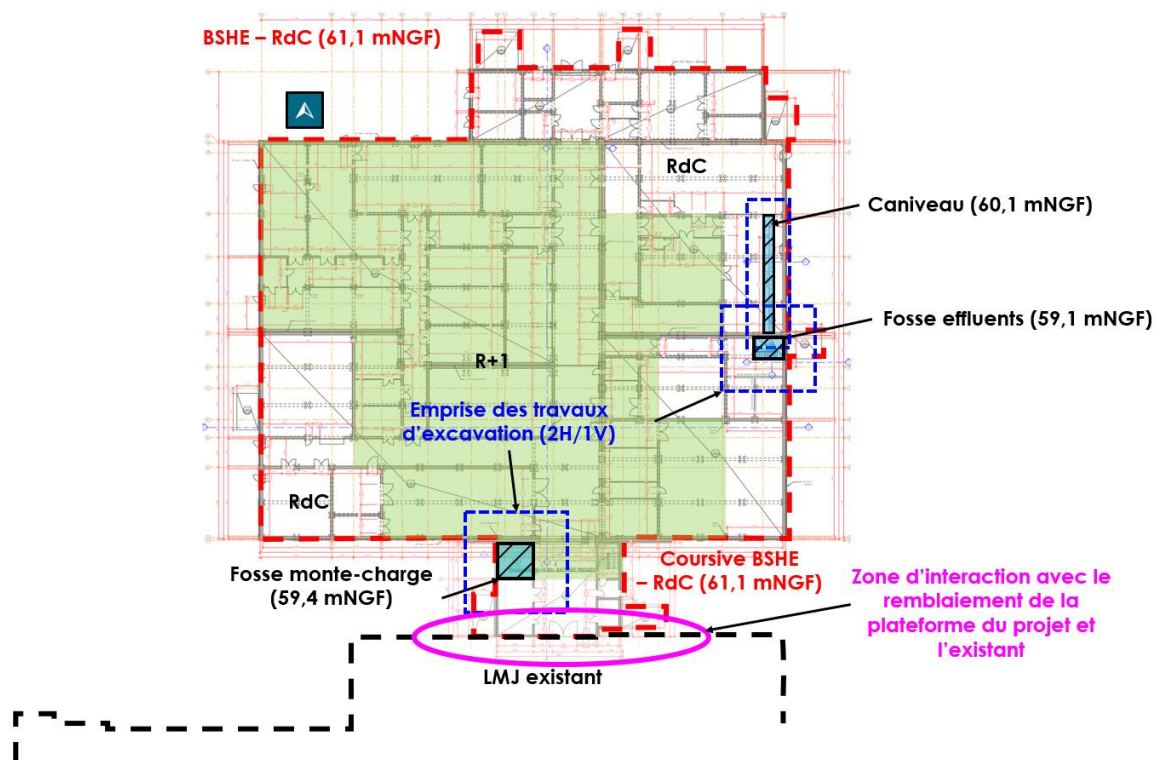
Zone d'emprise des travaux d'excavation – GÉOTEC – Sans échelle
